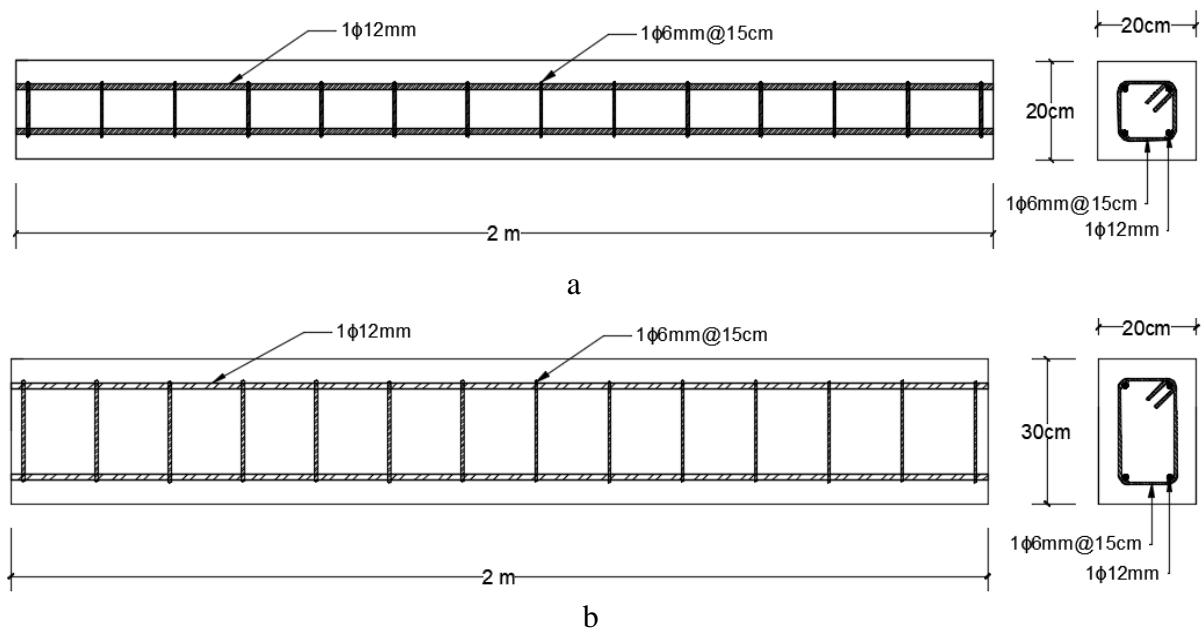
Geometría y distribución de acero, a) Viga 20x20, b) Viga20x30.
